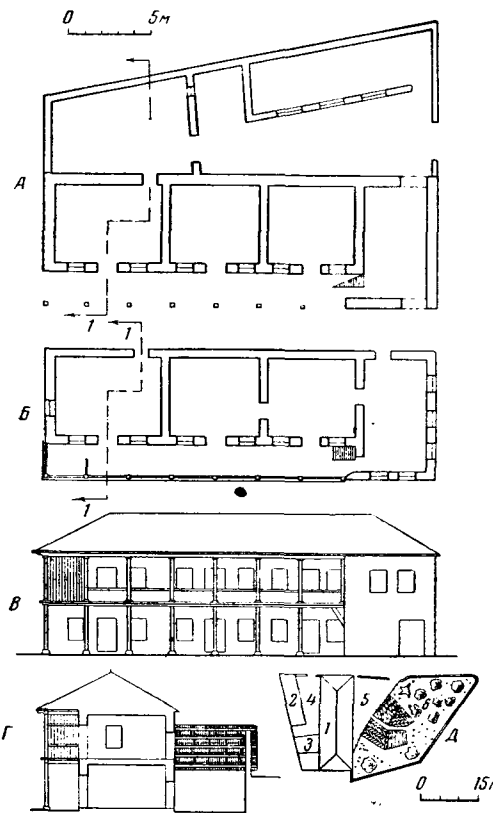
Новый сванский дом, Местия, *1955 г. А — план I этажа; Б — план II этажа; В — главный фасад; Г — разрез; Д — план усадьбы: 1 — жилой дом; 2 — «ламангар» (хлев); 3 — дарбази; 4 — хозяйственный двор; 5 — двор; 6 — плодовый сад (по материалам Сванской этнографической экспедиции Ин-та истории АН ГрузССР, 1955 г.)
